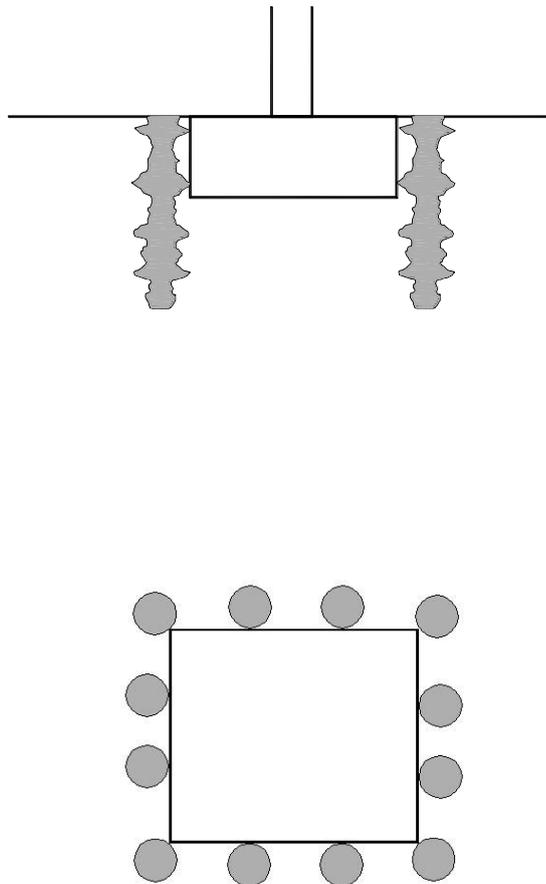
Croquis de recalce de zapata aislada con columnas de jet exteriores (confinamiento periférico)
